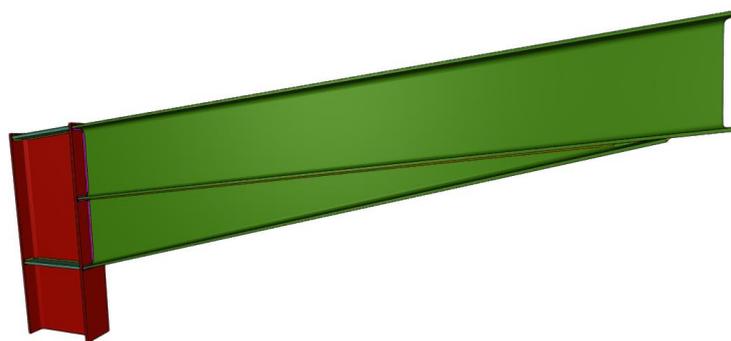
Vista unión viga-pilar pórticos intermedios
